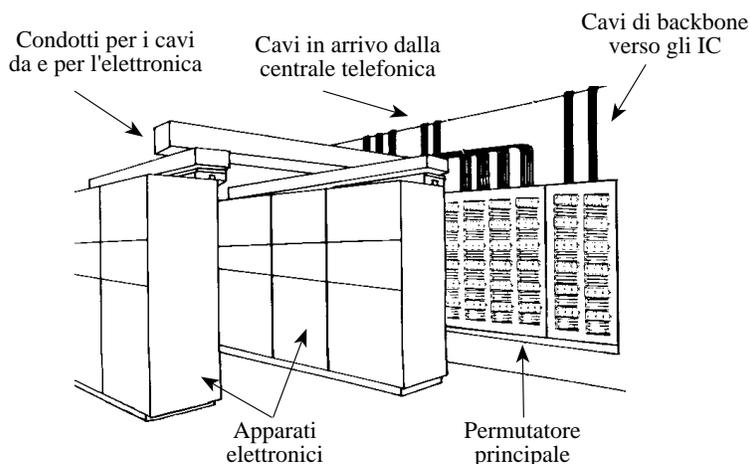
Esempio di Main Crossconnect all'interno di una Equipment Room.
